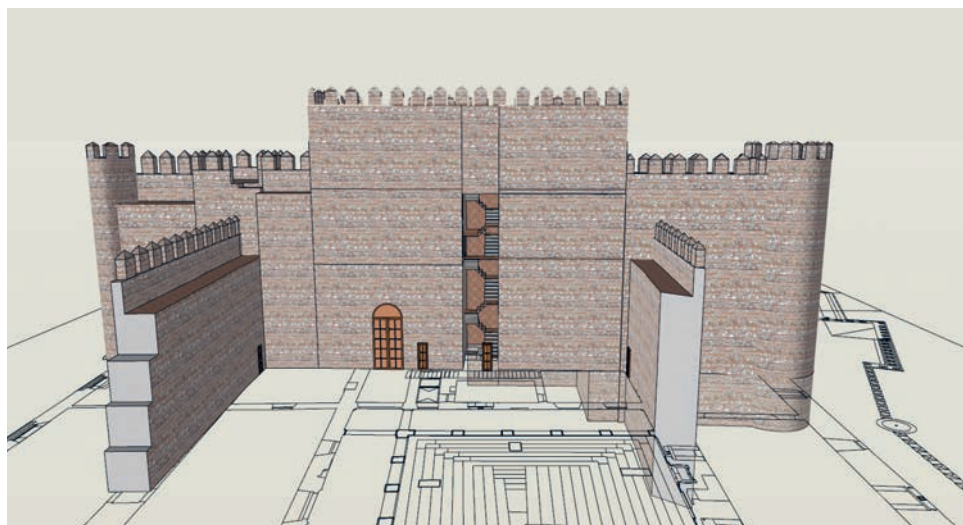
Vista del muro cortina con las torres central y norte con una segunda planta. Dibujo: Severino Riesgo.
